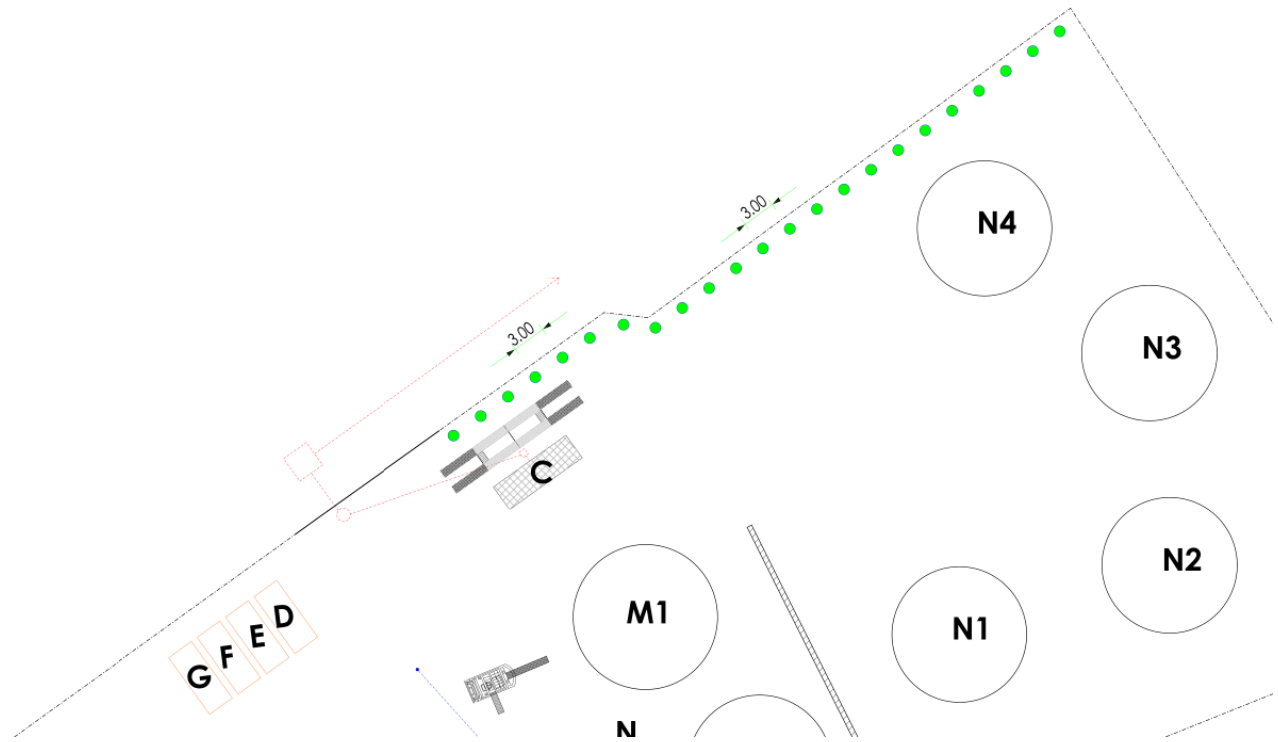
Individuazione Piantumazione con sesto d'impianto
